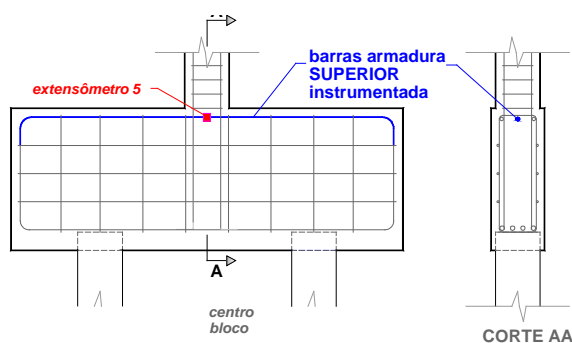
Posição do extensômetro na barra de armadura superior
